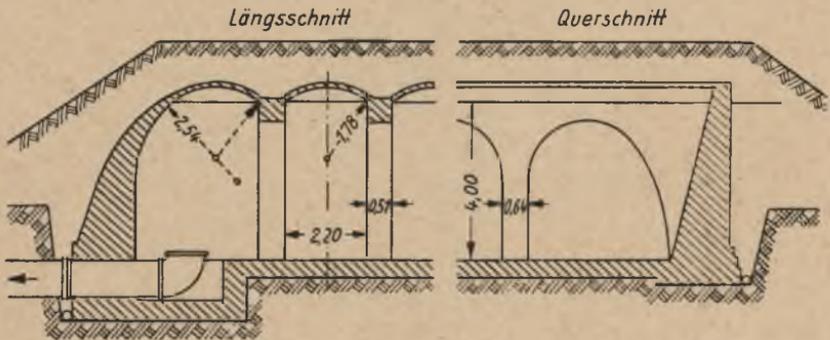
Erdbehälter aus Beton — Wasserwerk Leipzig
